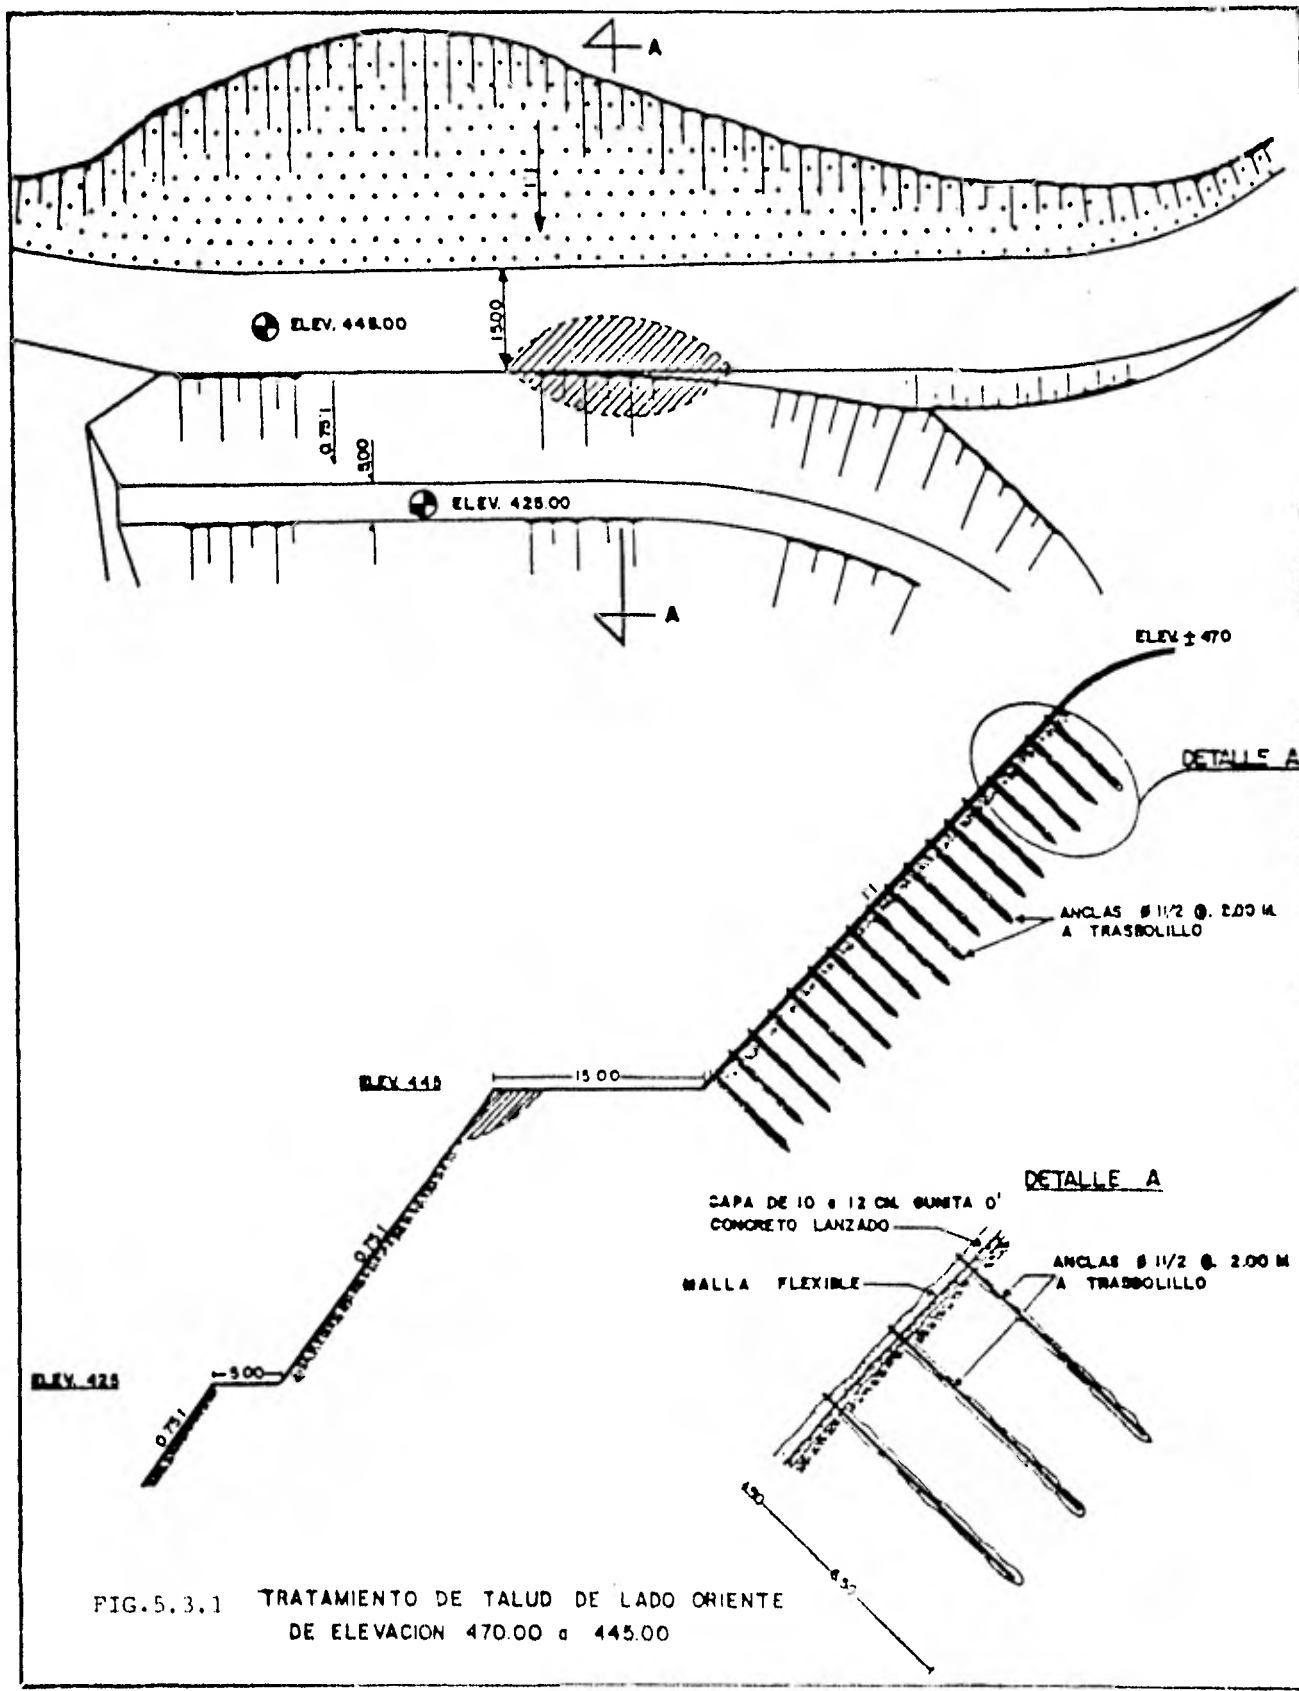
TRATAMIENTO DE TALUD DE LADO ORIENTE DE ELEVACION 470.00 a 445.00
